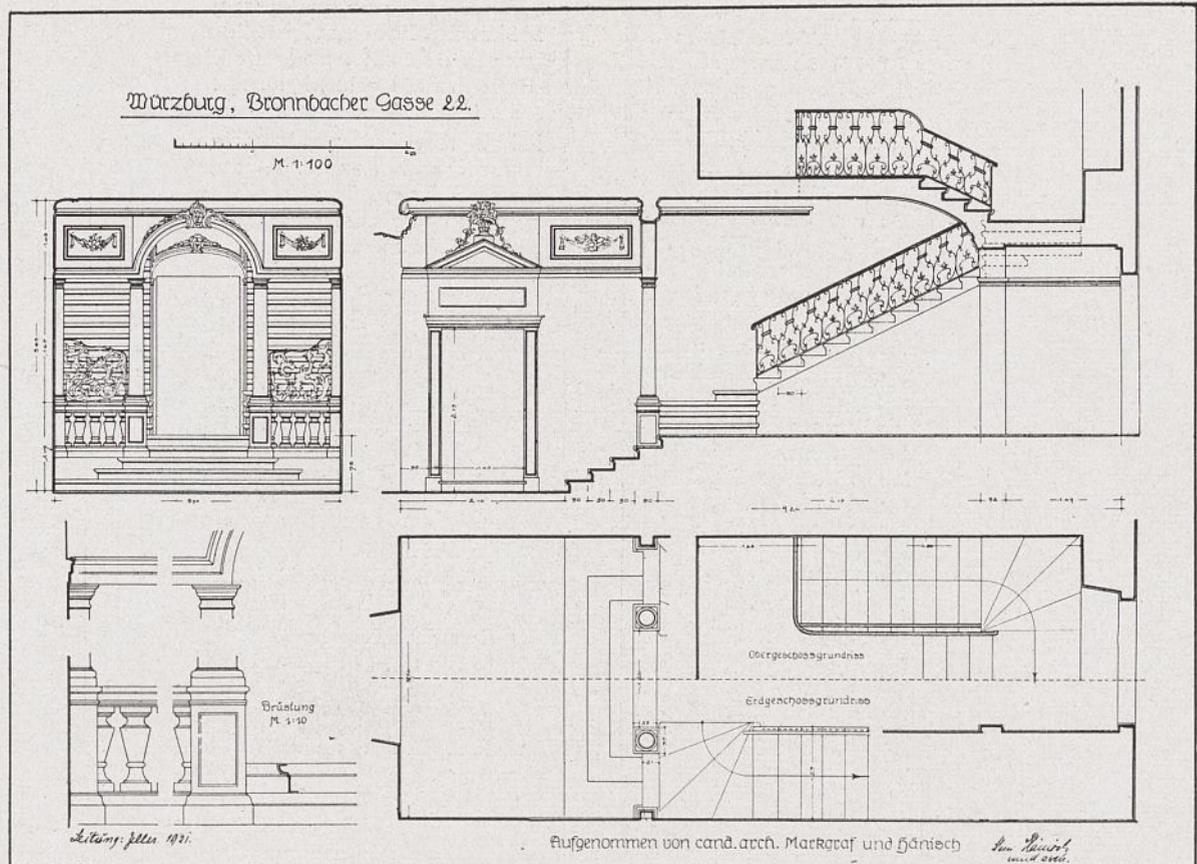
Treppenhaus Bronnbacher Gasse 22, Grundriß und Schnitte.
